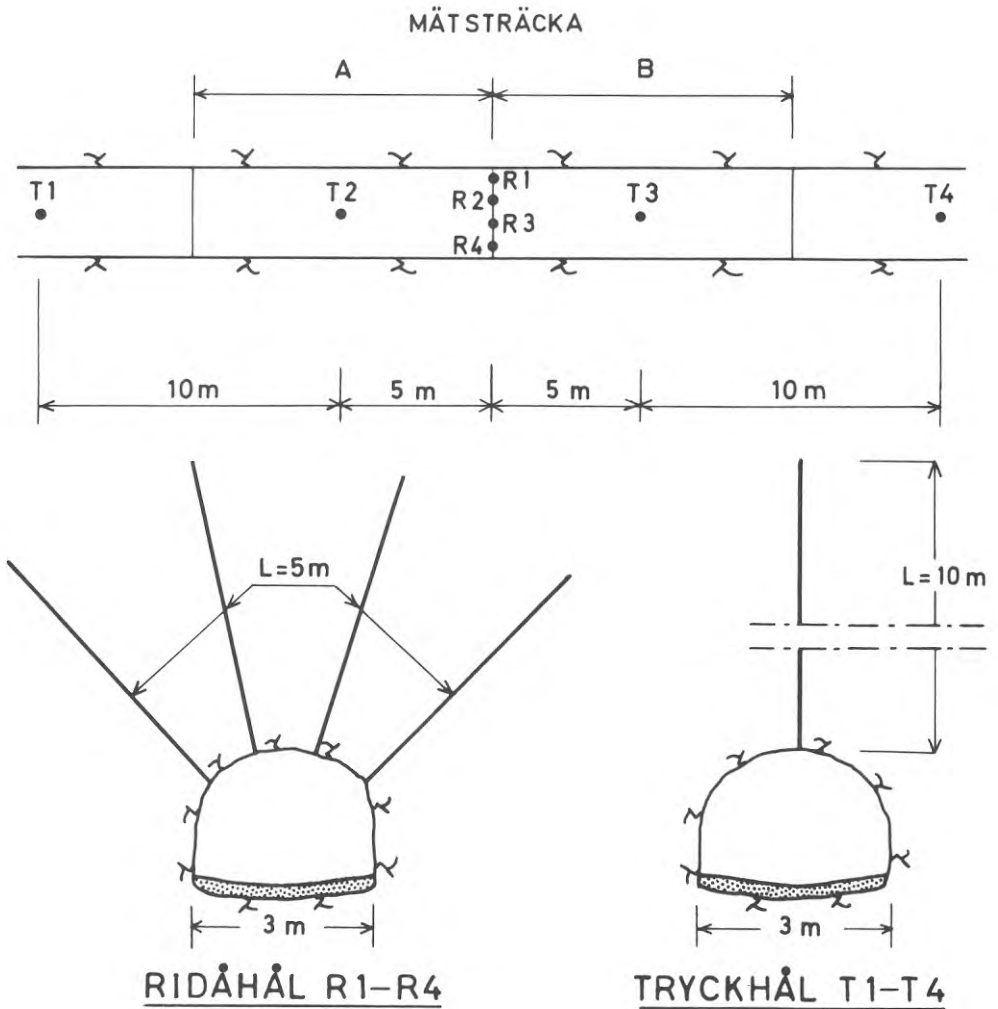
Placering av ridåhål R 1 - R 4 för att åtskilja provsträckorna A och B. Borrhålen T 1 - T 4 avsåg att bestämma påliggande grundvattentryck.
